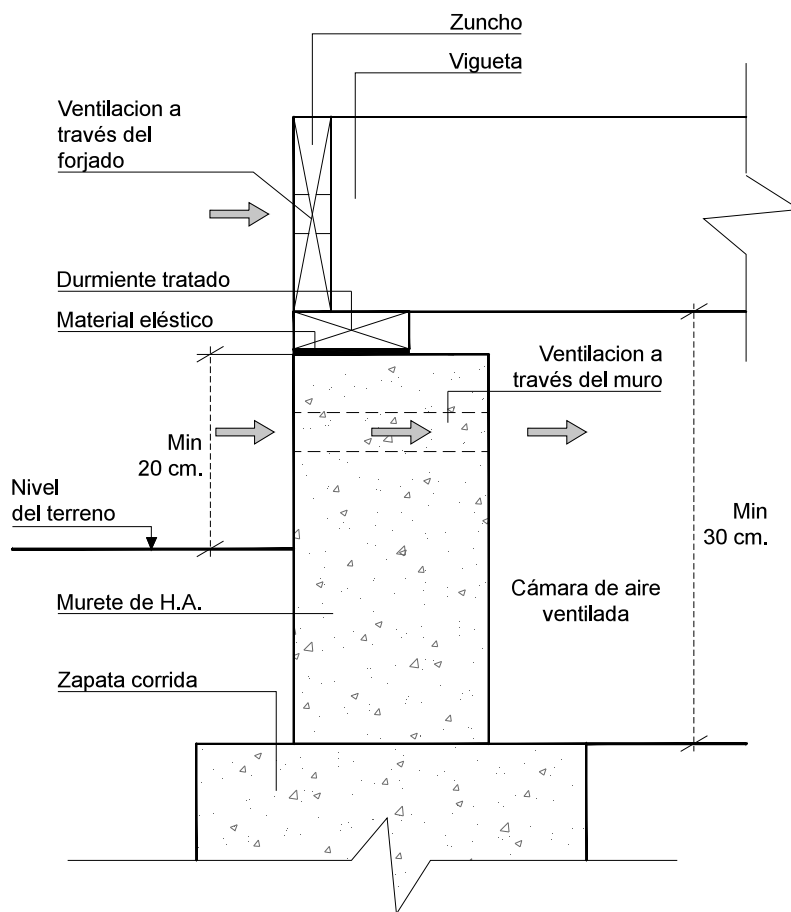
Detalle constructivo de primer forjado sobre una cámara de aire.
